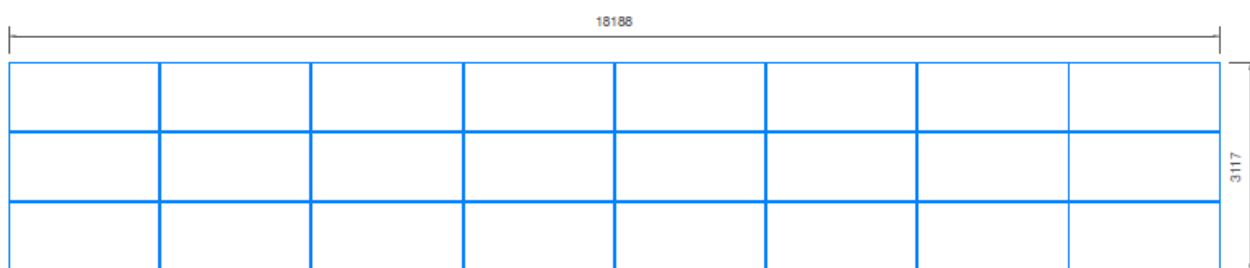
Strutture di sostegno fisse: vista in pianta (quote in mm)
